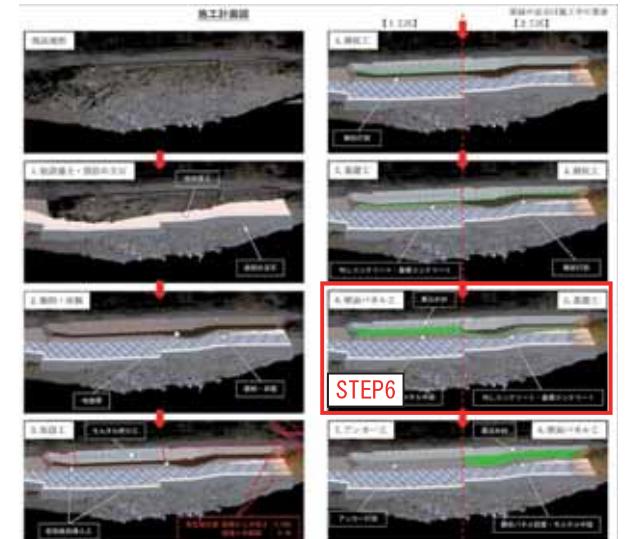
施工計画図への活用(一部抜粋：現況地形, STEP1～7)
